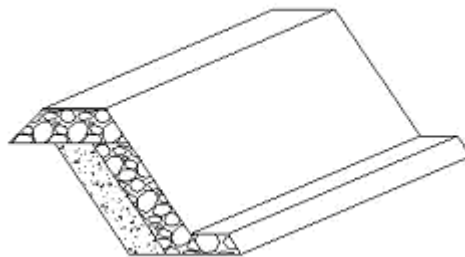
Estrutura longitudinal aderente com secção transversal simples.
